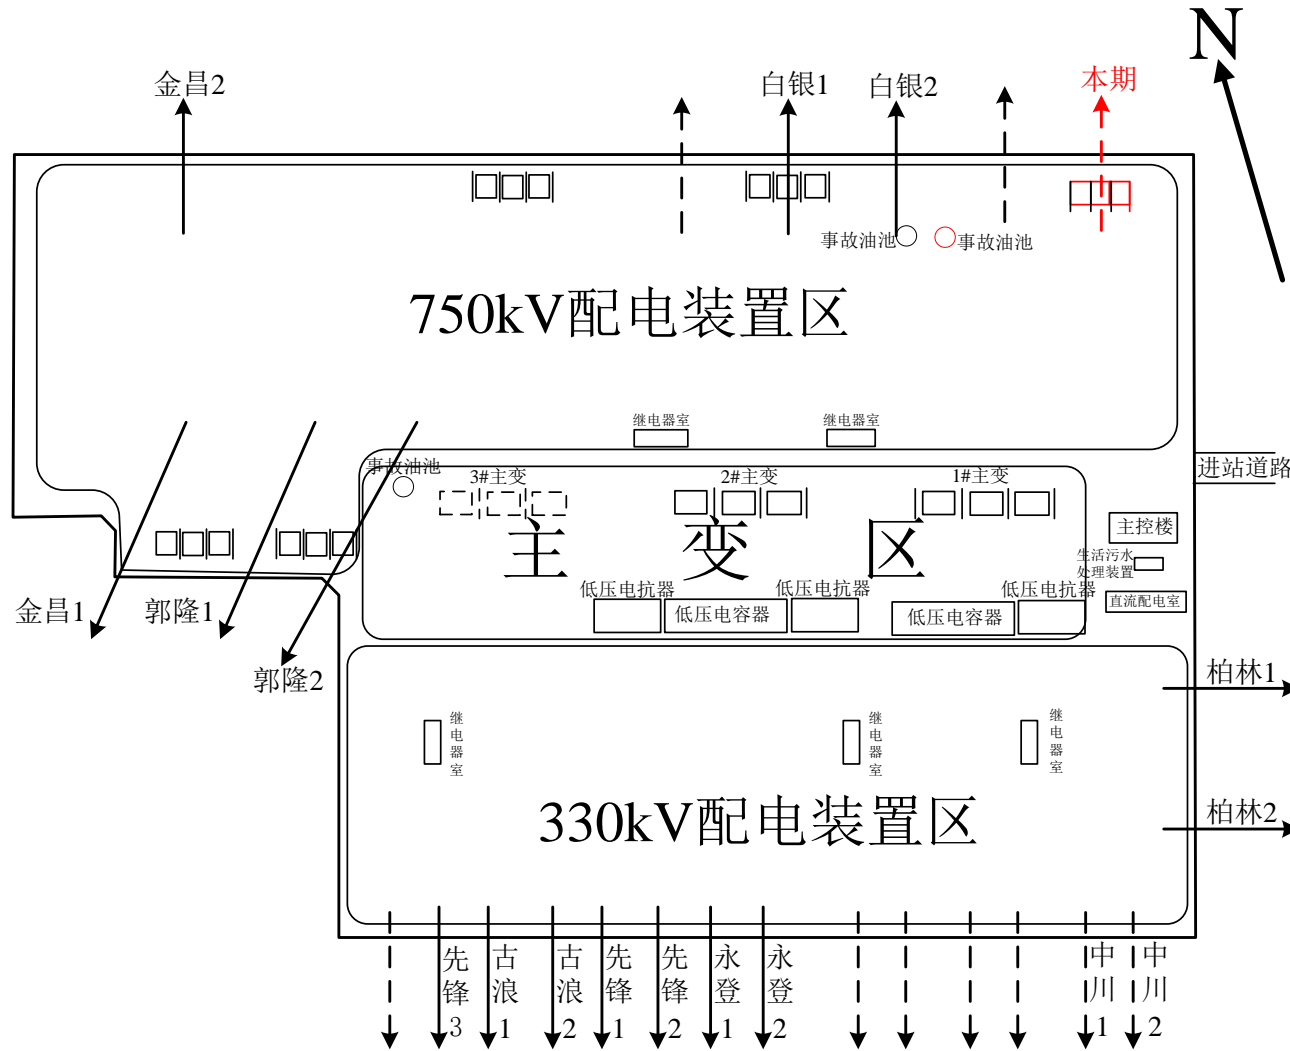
武胜 750kV 变电站总平面布置示意图
